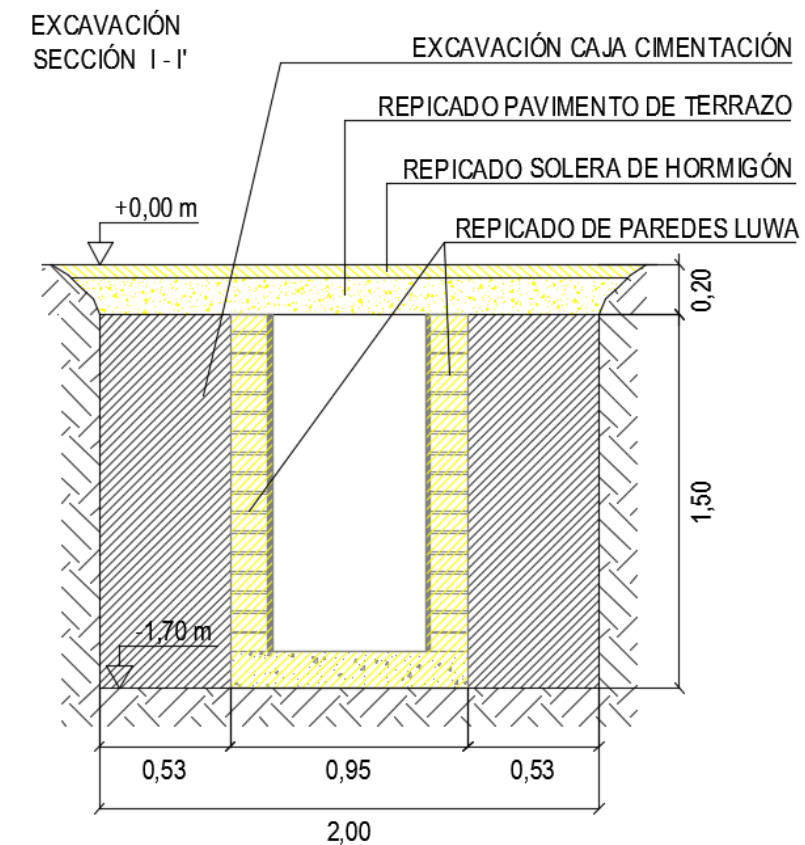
Sección detalle I-I' (EXCAVACIÓN)
